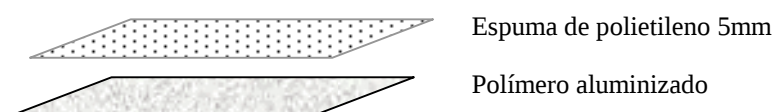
Composição do conjunto termo-soldado da subcobertura 4.
